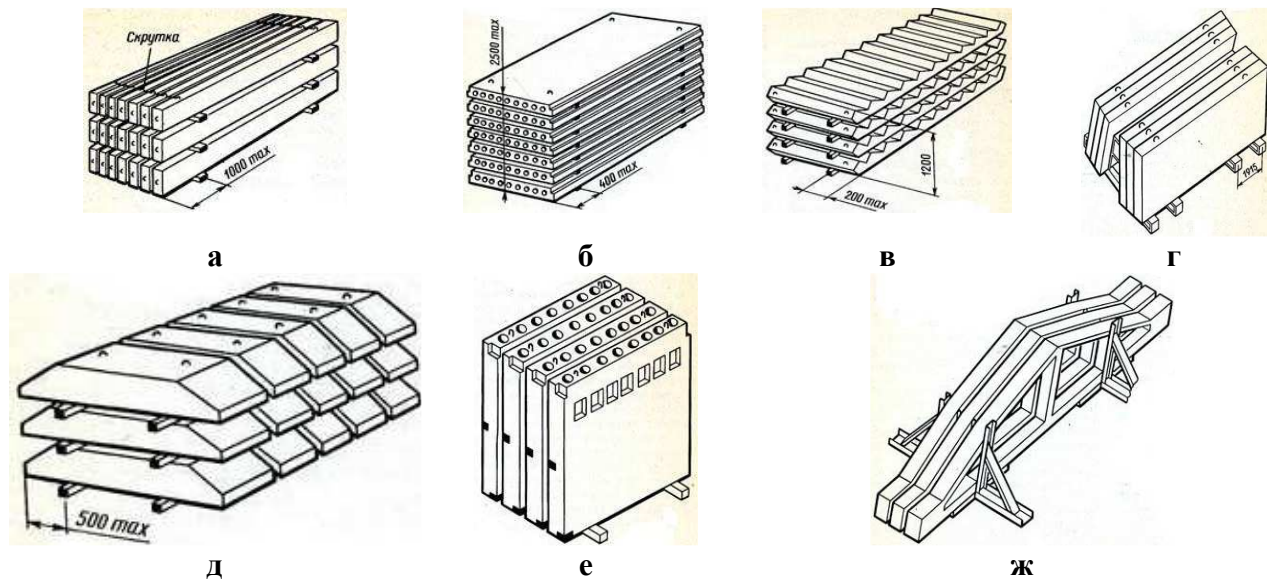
Складування збірних залізобетонних конструкцій: а – прогони; б – плити перекриття; в – сходові марші; г – панелі стінові; д – подушки фундаментні; е – блоки вентиляційні; ж – ферми
